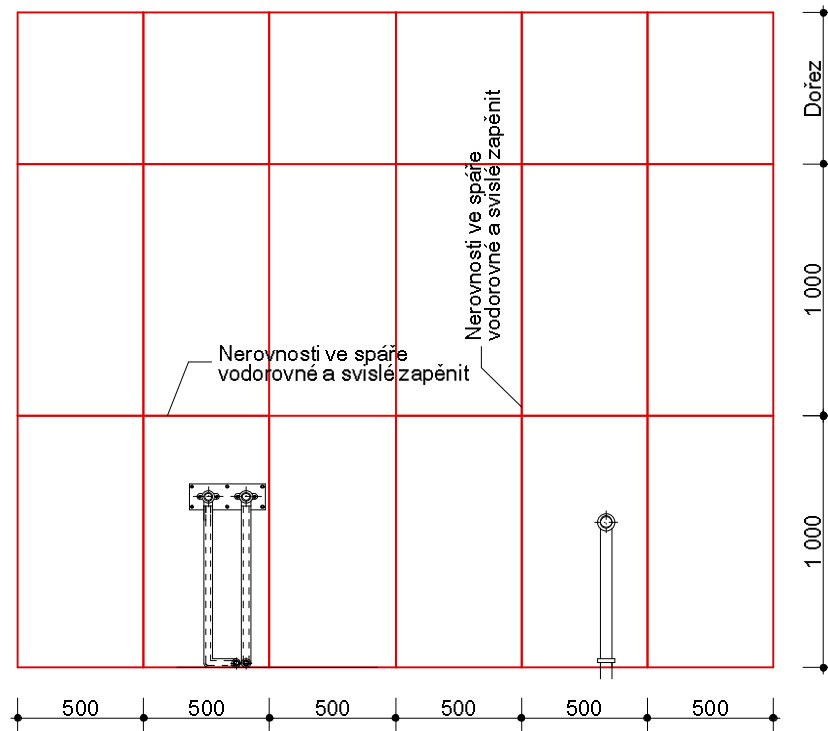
SCHÉMA KLADENÍ TEPELNĚ-IZOLAČNÍ VRSTVY PŮDORYS
